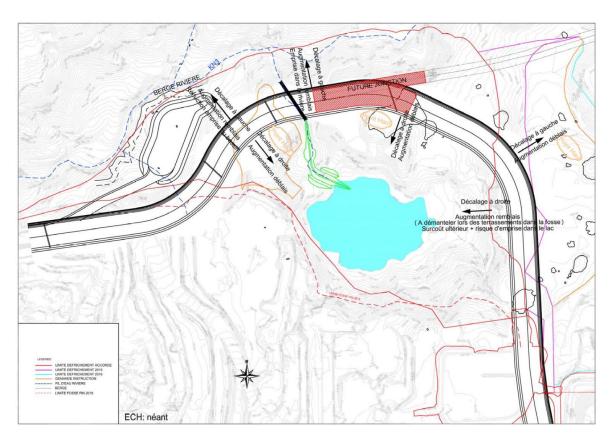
Vue en plan de l'extension de la voie de roulage Nord
